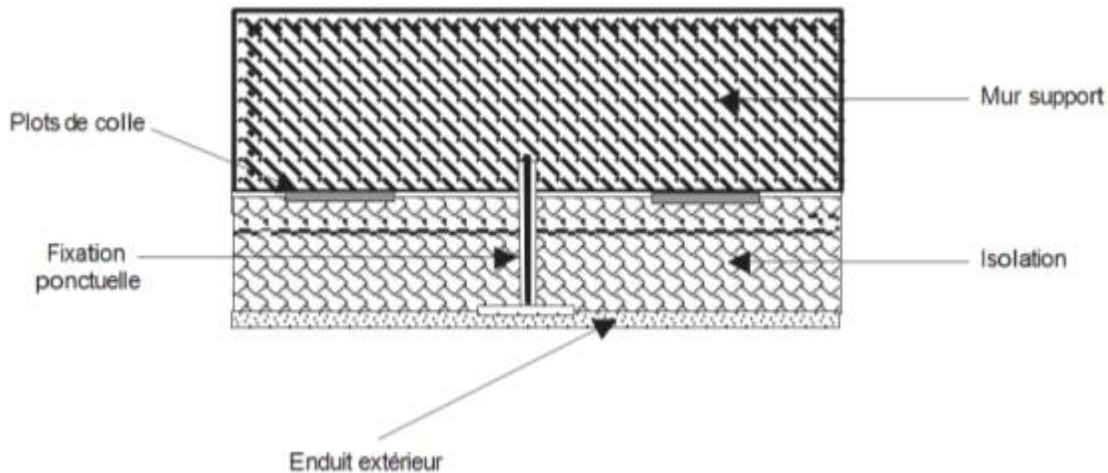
Principe de l'isolation par l'extérieur de type enduit sur isolant (coupe horizontale)
